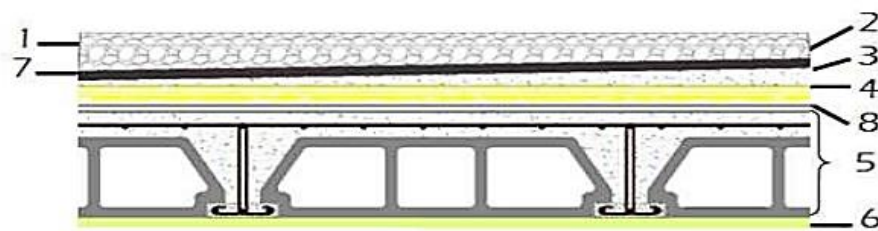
Coupe du plancher terrasse en corps creux (inaccessible)
